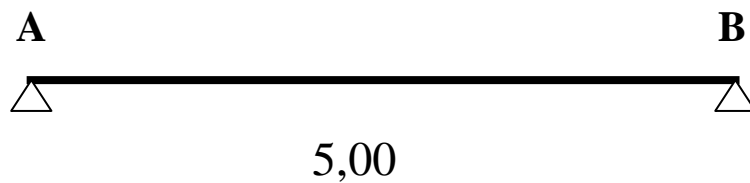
Schéma statique de la poutrelle Type T3 (étage courant, RDC et sous sol).
